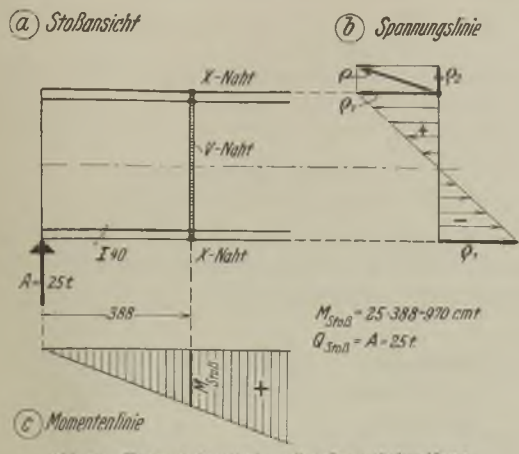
Trägerstoß mittels voller Stumpfschweißung.
